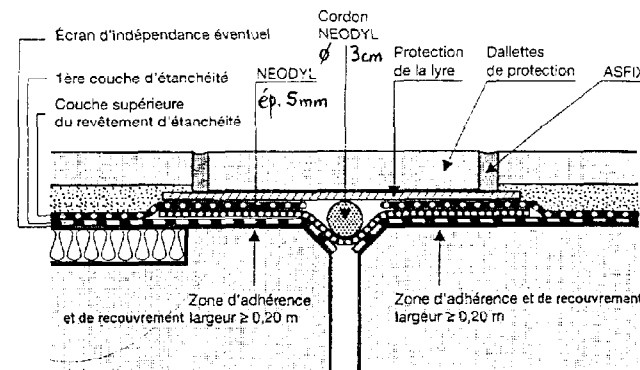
Revêtement d'étanchéité bitumineux, joints plats en partie courante
